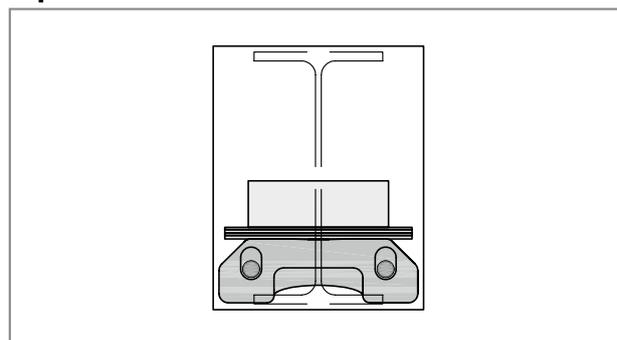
Schöck Isokorb® T type SQ : les entretoises de la plaque d'absorption de la charge surélèvent l'emplacement de la poutre en acier de 20 mm maximum.
